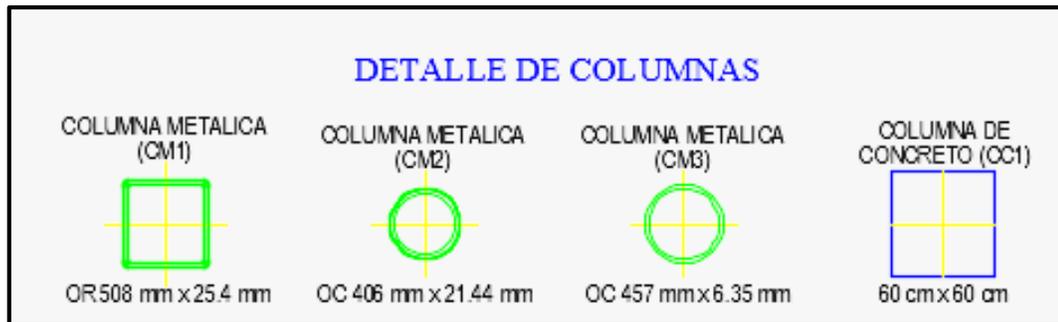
Detalle de columnas soportadas por los cabezales.
